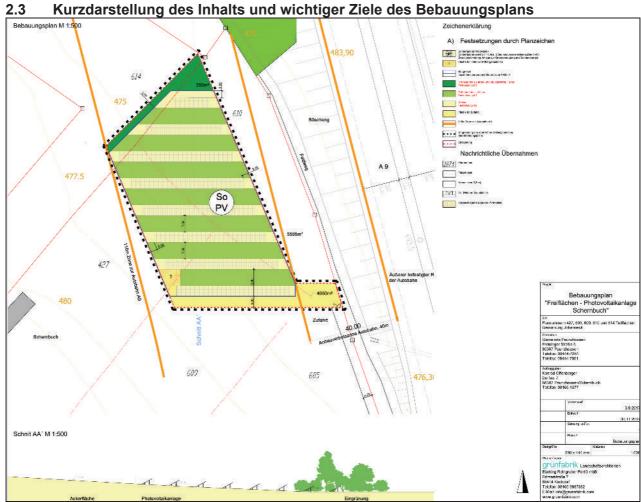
Bebauungsplan "Freiflächen - Photovoltaikanlage Schernbuch'
